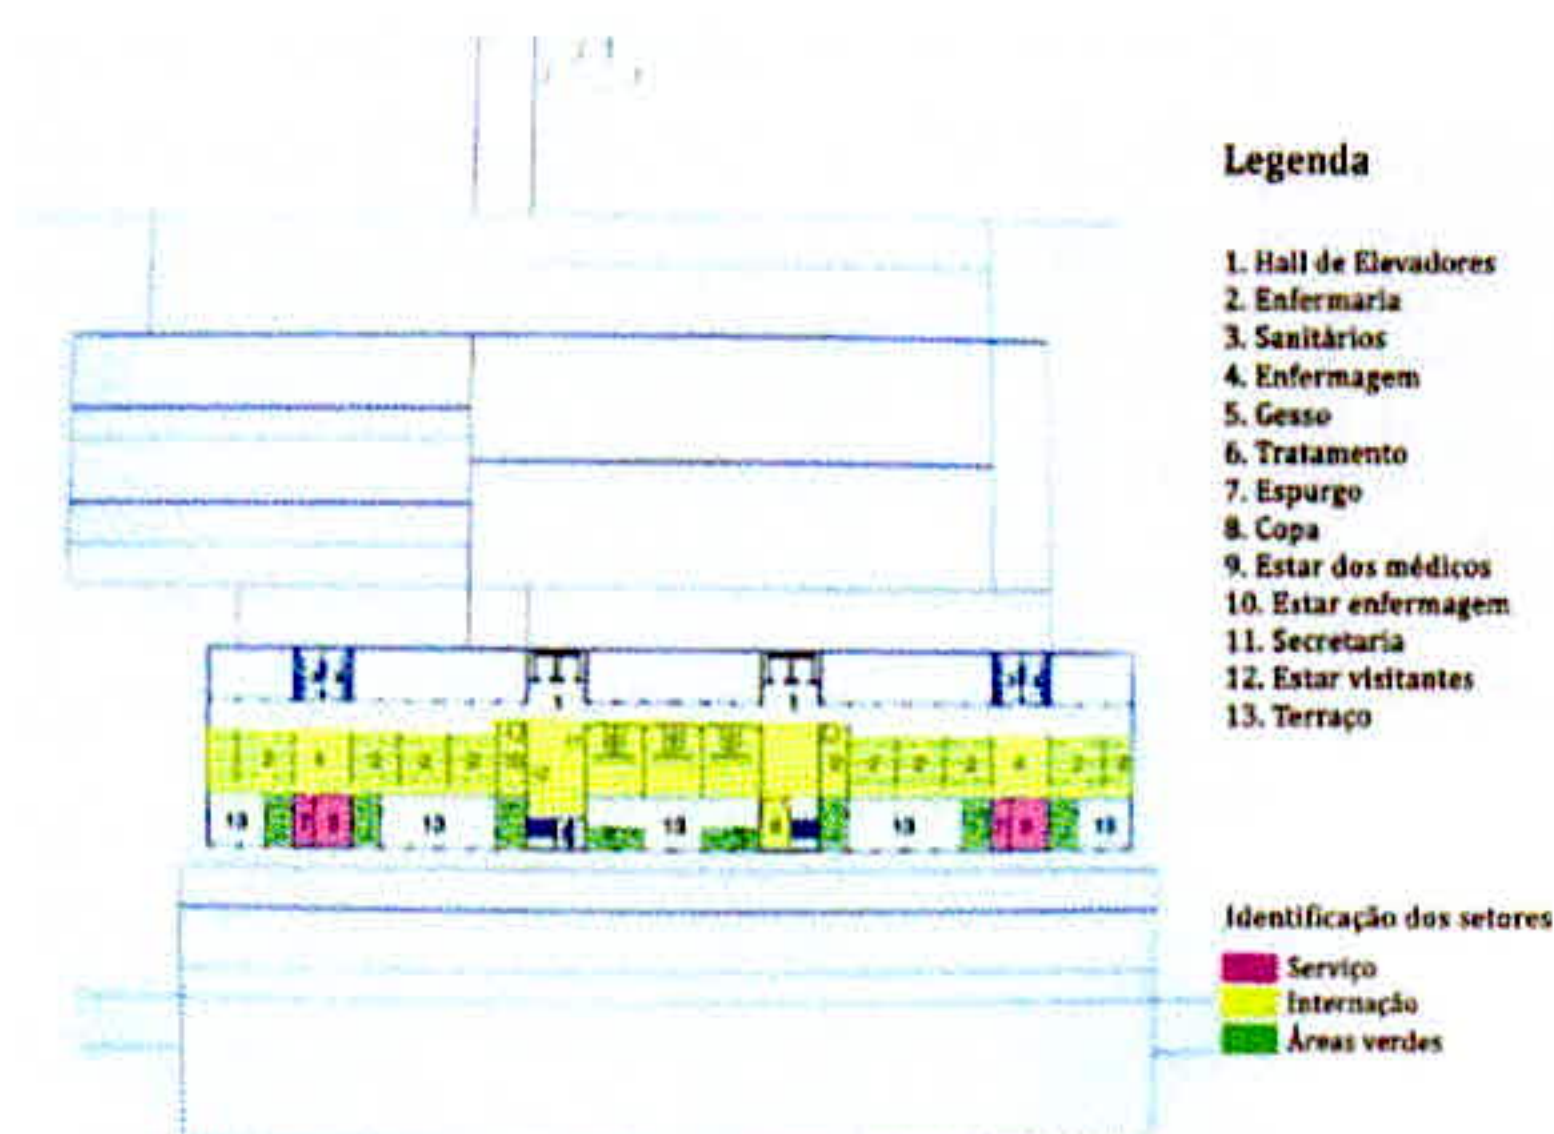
Planta de setorização - Nível +3,50. Fonte: FEITOZA, T.B (2011).
